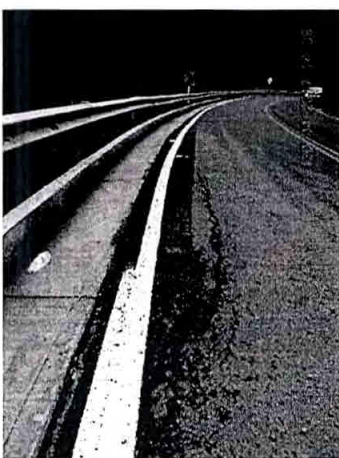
Fisuras en la carpeta asfáltica
